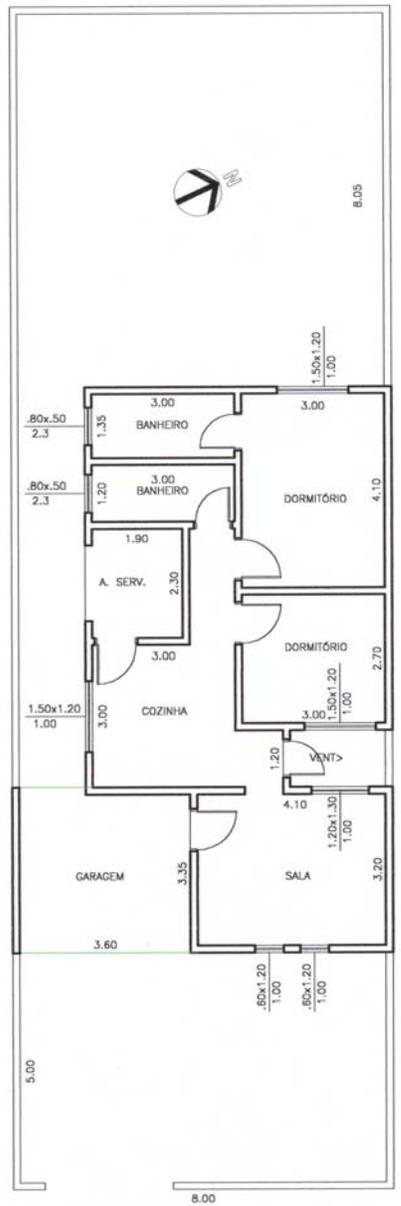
Loteamento Jardim Santa Adélia Q R lote 8
